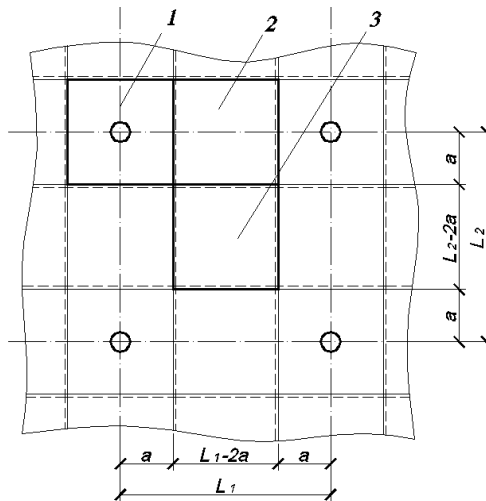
Фрагмент розрахункової схеми сталезалізобетонного безбалкового перекриття:
